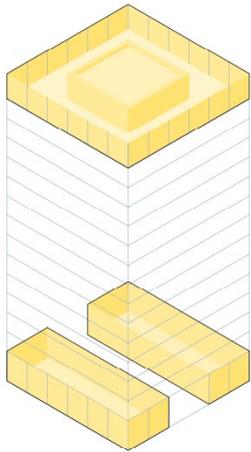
Nachbarschaftsräume im Erd- und Dachgeschoss | Studio Ele (Köln)
